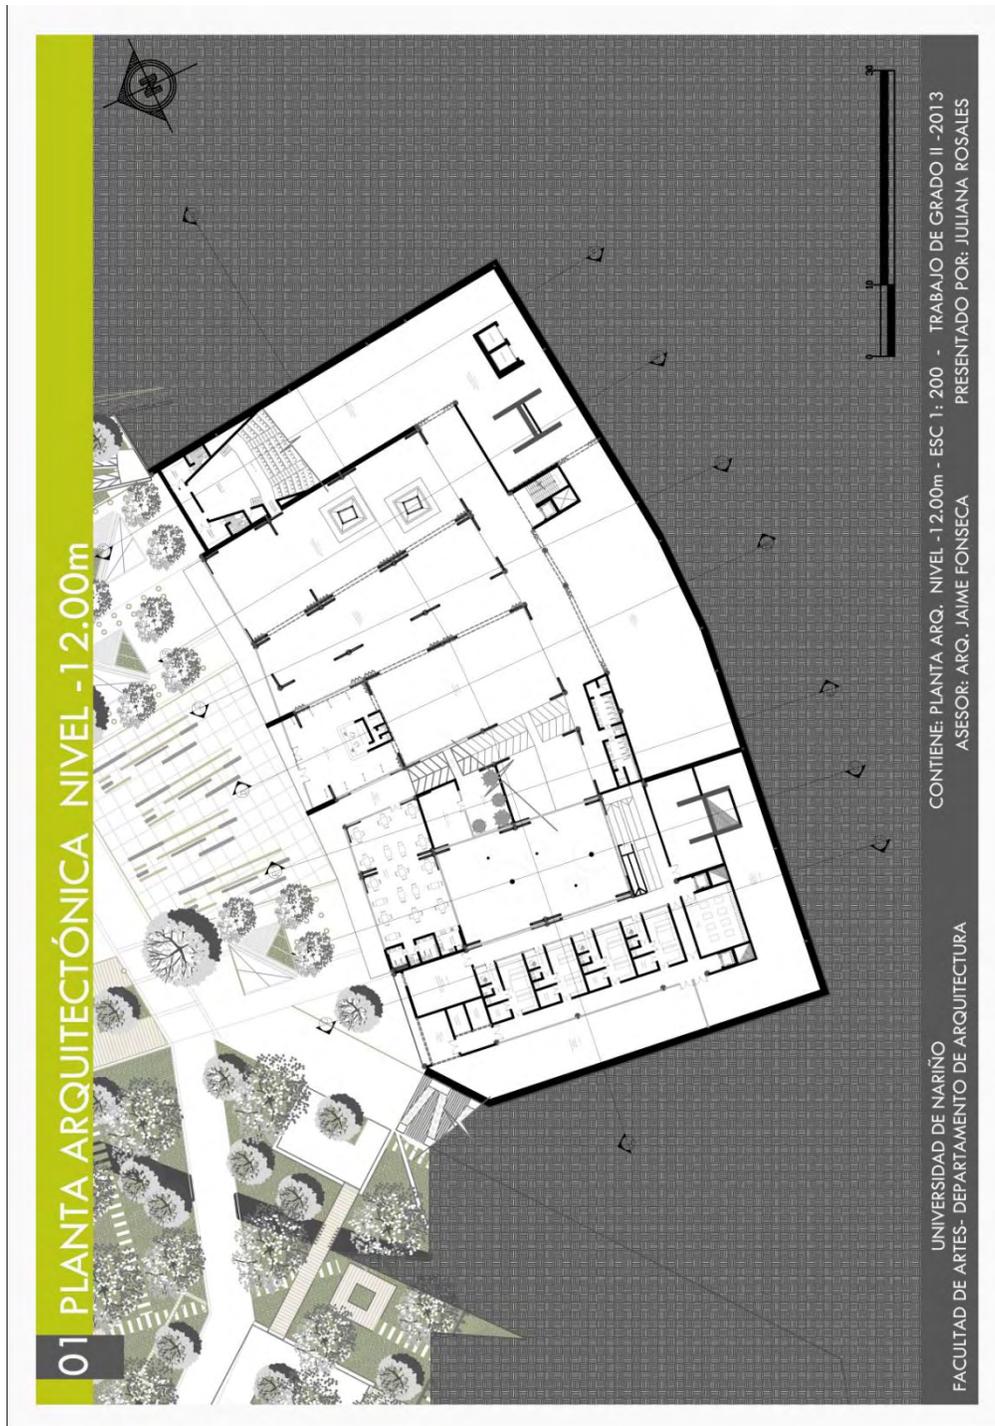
Proyecto_Planta nivel -12.00m // Fuente esta investigación
